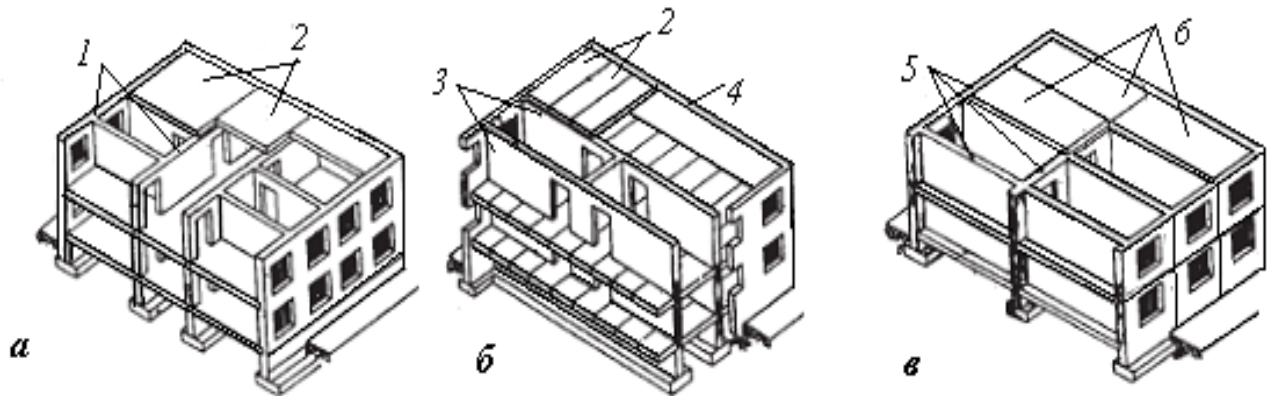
Конструктивні схеми безкаркасних будівель: а – з повздожнім розташуванням несучих стін; б – з поперечним розташуванням несучих стін; в – з поперечними і повздожніми несучими стінами. 1 – зовнішні і внутрішні несучі стіни; 2 – плити міжповерхового перекриття; 3 – внутрішні поперечні несучі стіни; 4 – торцева несуча стіна; 5 – повздожні і поперечні несучі стіни; 6 – плити перекриття, оперті по контуру
